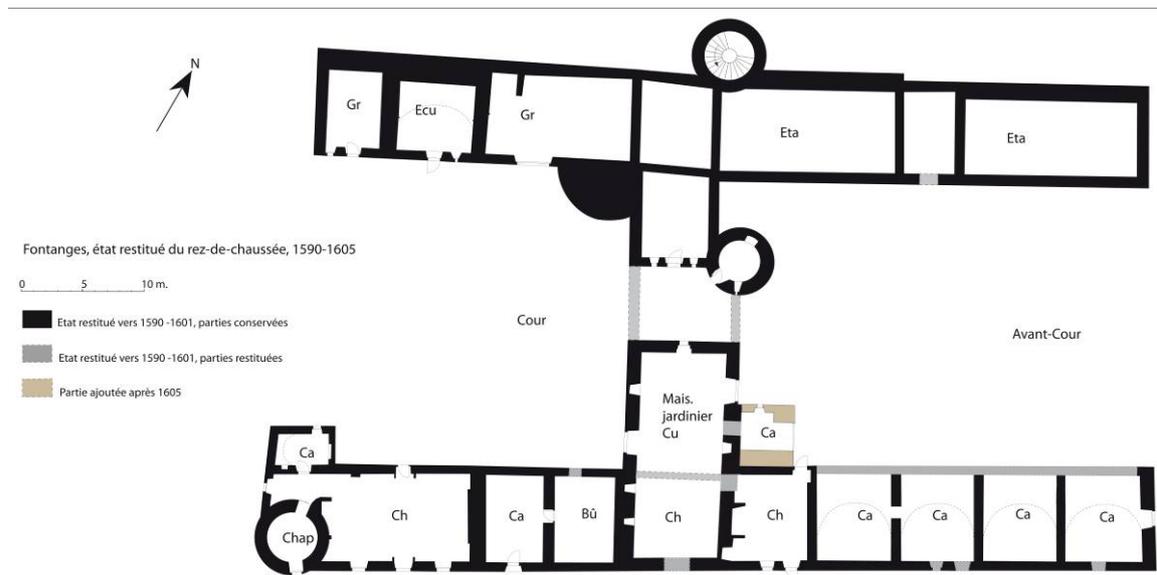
Plan restitué du rez-de-chaussée vers 1590-1605.
